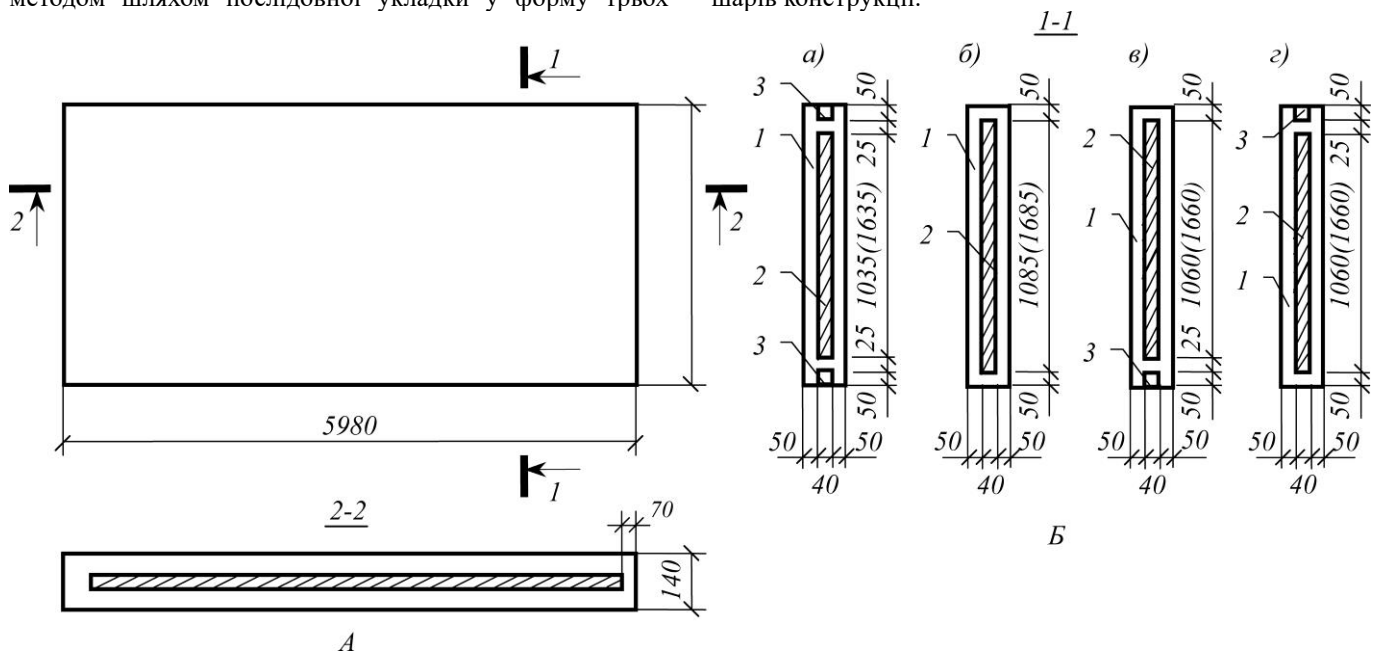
Конструкція тришарової стінової панелі (шифр 336-70): А – фасад і поздовжній розріз панелі (закладні деталі, поздовжні та поперечні ребра-діаграми на фасаді умовно не показані); Б – поперечні перерізи; а – рядової панелі; б – міжвіконної перемичкової; в – підвіконної перемичкової; г – надвіконної перемичкової; 1 – бетон класу В22,5...В25; 2 – пінополістирол марки ПСБ, $\gamma=20$ кг/м³; 3 – те ж саме, ПСБС, $\gamma=20$ кг/м³.
